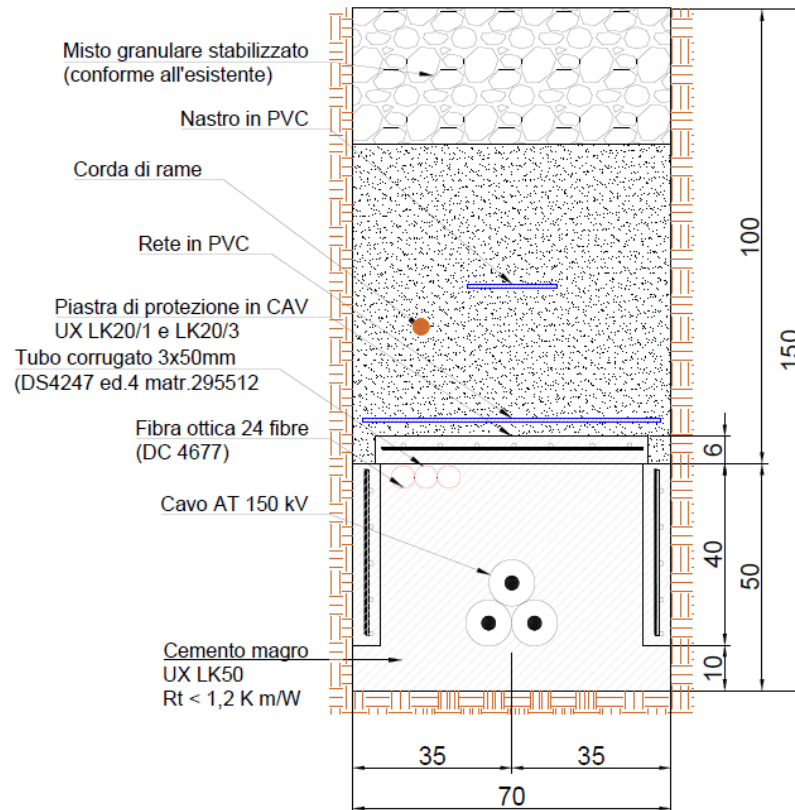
Tipico di sezione cavidotto AT su strada bianca.
